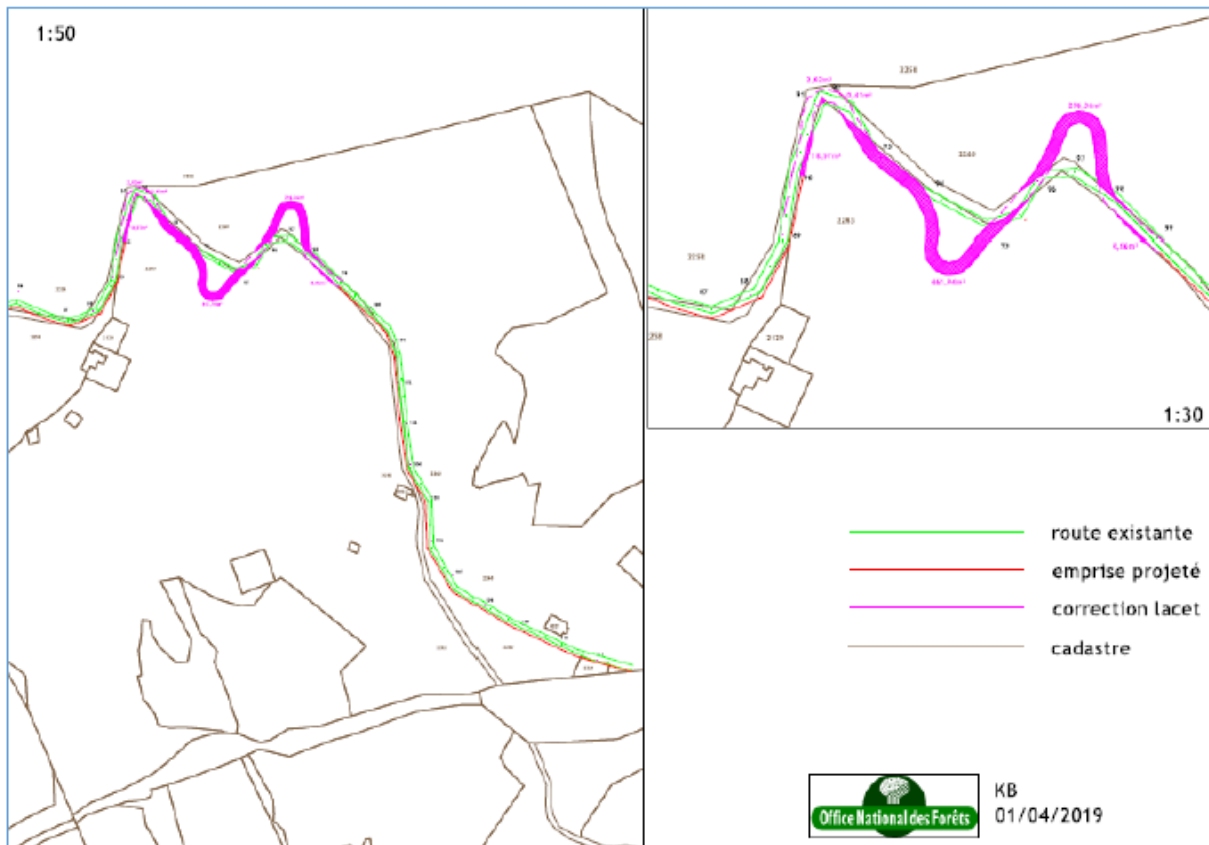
Plan cadastral : reprise du lacet du col de Voza (ONF)
